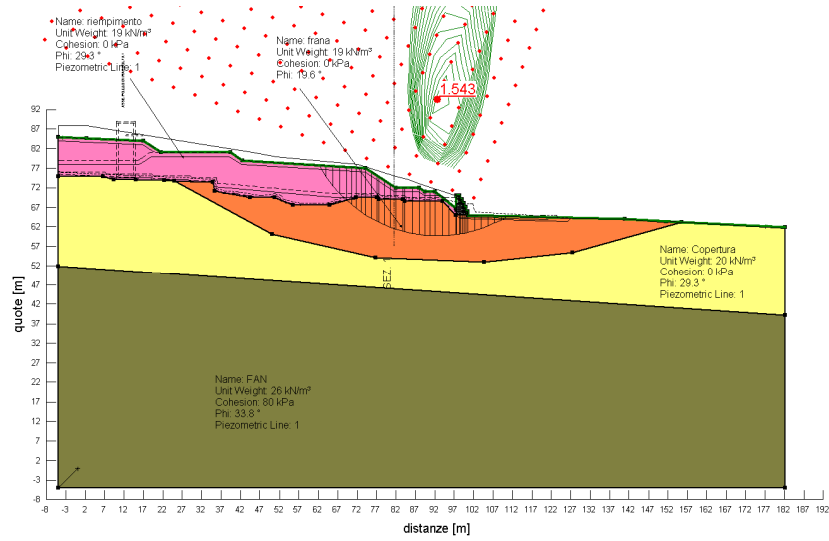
Stabilità rilevato finale - combinazione Statica
